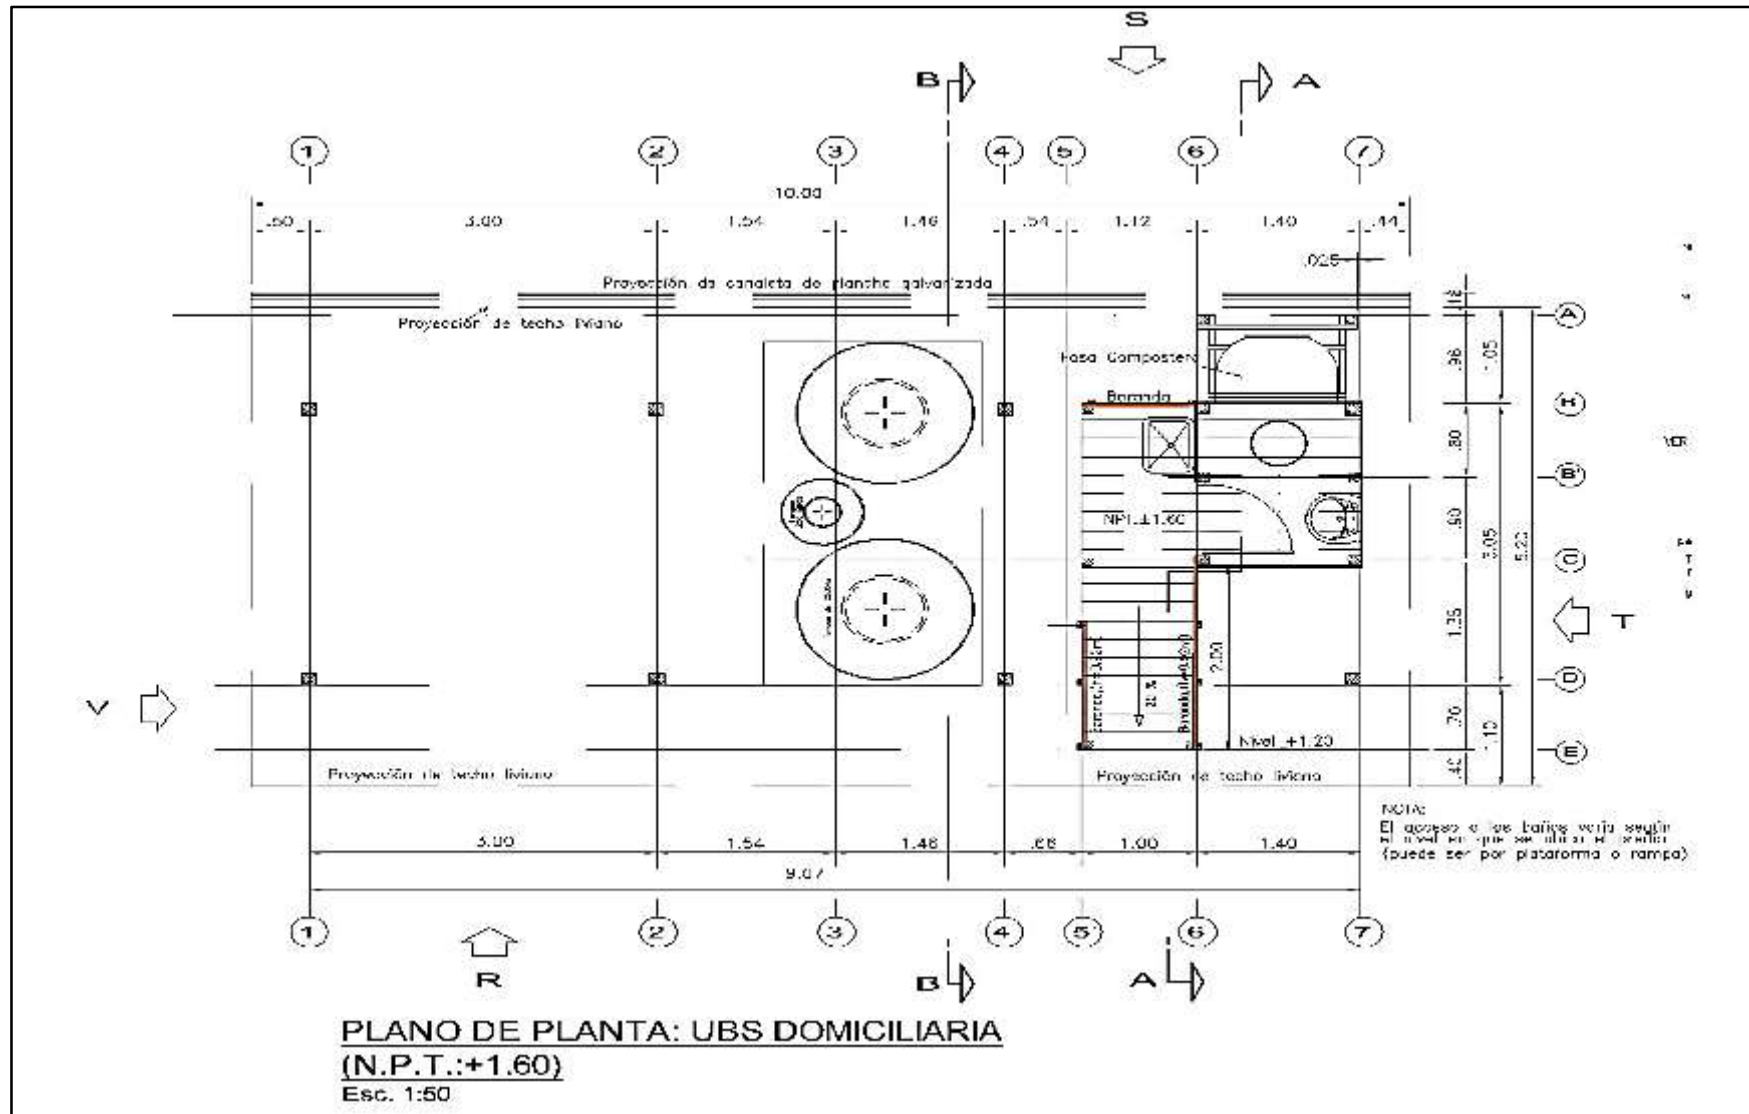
plano de planta del módulo domiciliario UBS mediante el sistema de madera
